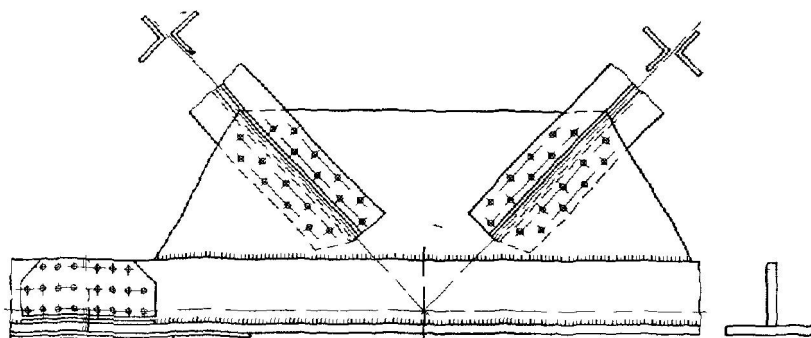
Вузол головної ферми з тавровими перетинами поясів.
